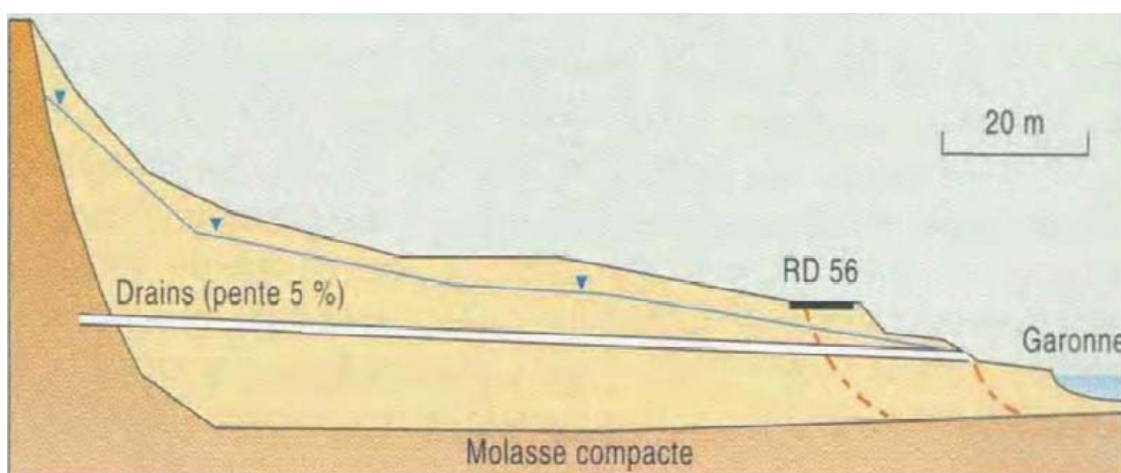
Stabilisation par drains subhorizontaux de la RD à Muret (Haute-Garonne, France)
